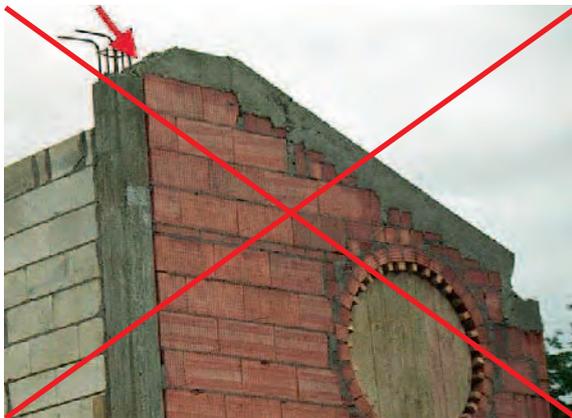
Am Giebelübergang fehlt die Anschlussbewehrung zum Ringbalken. Dies führt zu Rissen, s. Bild 12.3-3
